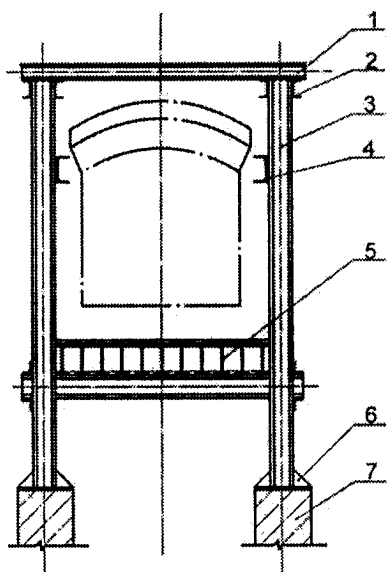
Рамний жорсткий каркас: 1 — поперечна пов'язь; 2 — поздовжня пов'язь (прогон); 3 — стоек; 4 — підп'ятова балка; 5 — подова рама; 6 — башмак стояка з опорною плитою; 7 — фундамент
